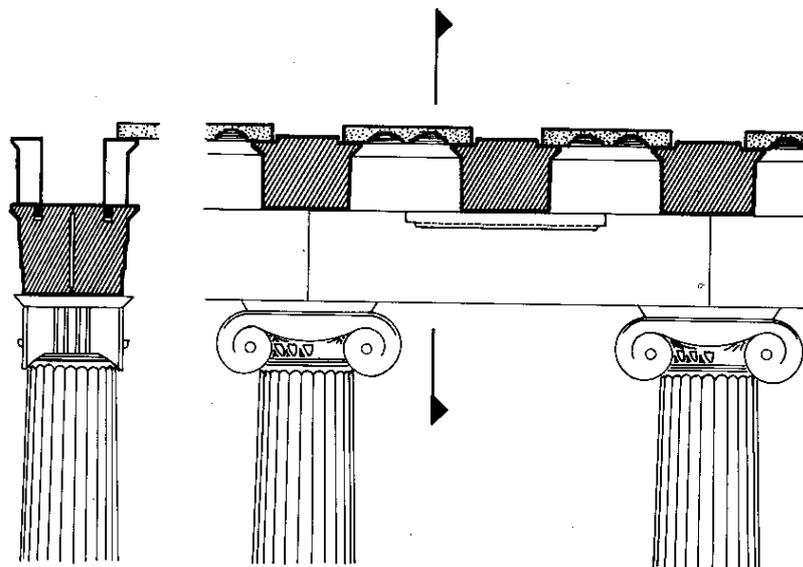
Propylaea, Atenas – Barra de ferro inserida na viga sobre os pilares
